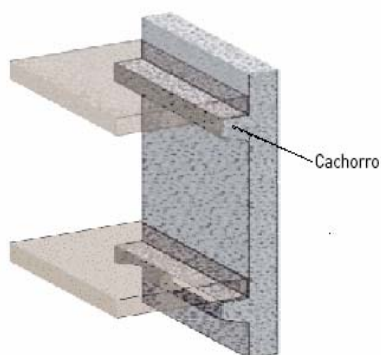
Exemplo esquemático de ligação fraca em estrutura pré-fabricada.
